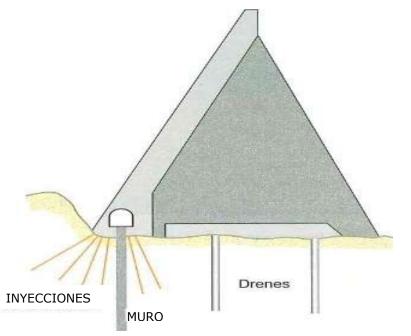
III.1.2.4 Presa contrafuerte con cimentación de muro e inyecciones.
